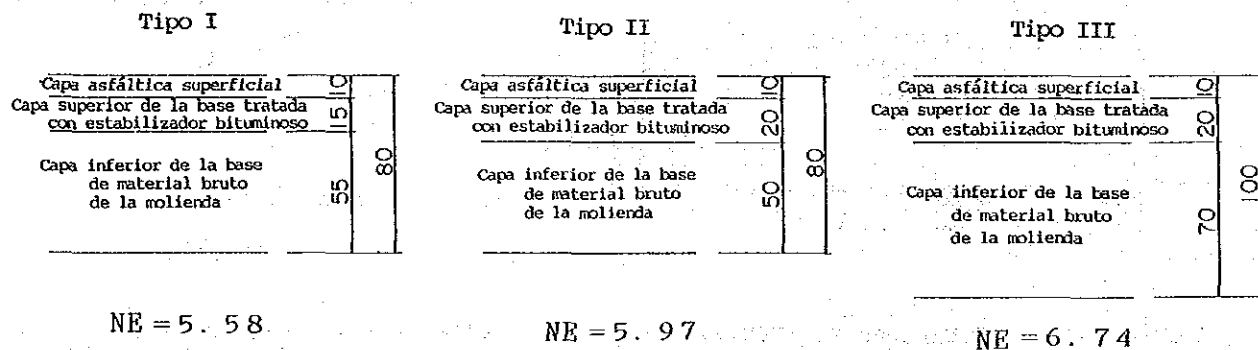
PLANO DE TIPOS DE ESTRUCTURAS DE LOS PAVIMENTOS EXISTENTES
